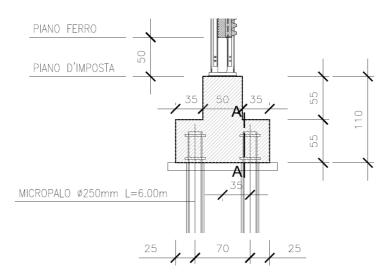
sezione fondazione di linea BFA (BA16-BA17)
